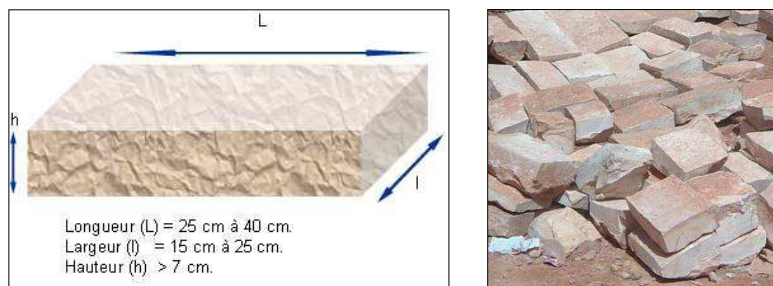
Pavage en pierre taillée de forme rectangulaire [82]
